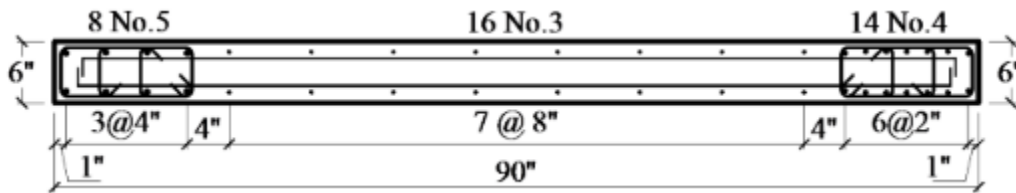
Detallado y refuerzo del espécimen WP1 (Segura, 2017).
